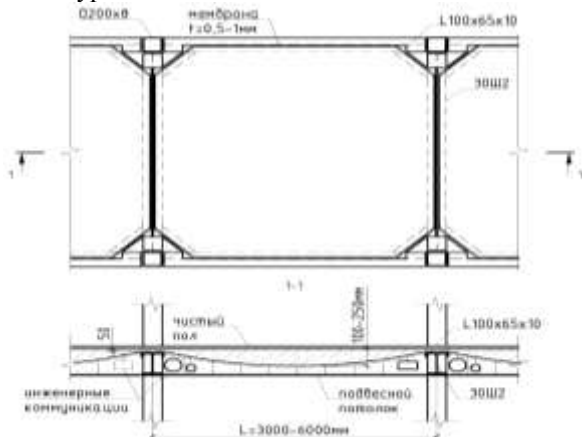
Конструкция сталежелезобетонного мембранного перекрытия
